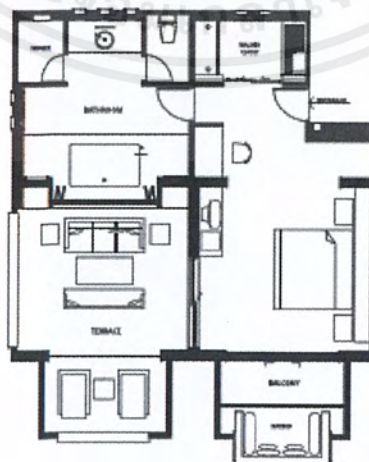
แสดงผังห้องแบบ Horizontal view
